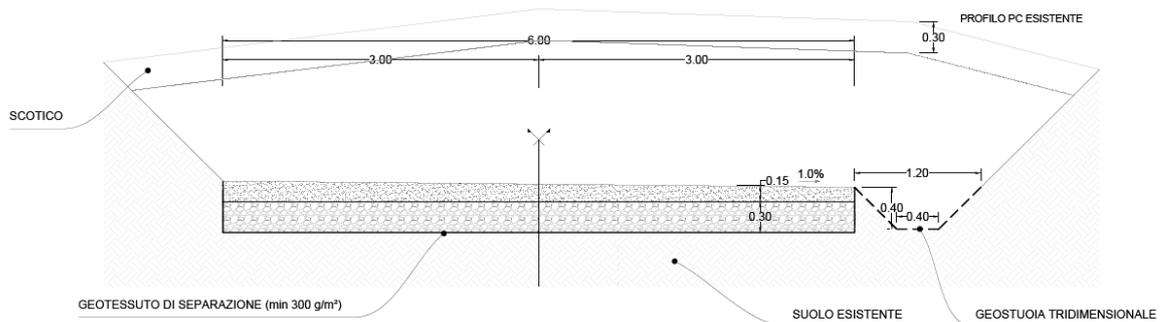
Sezione trasversale viabilità di nuova realizzazione. Fonte: elaborato di progetto
